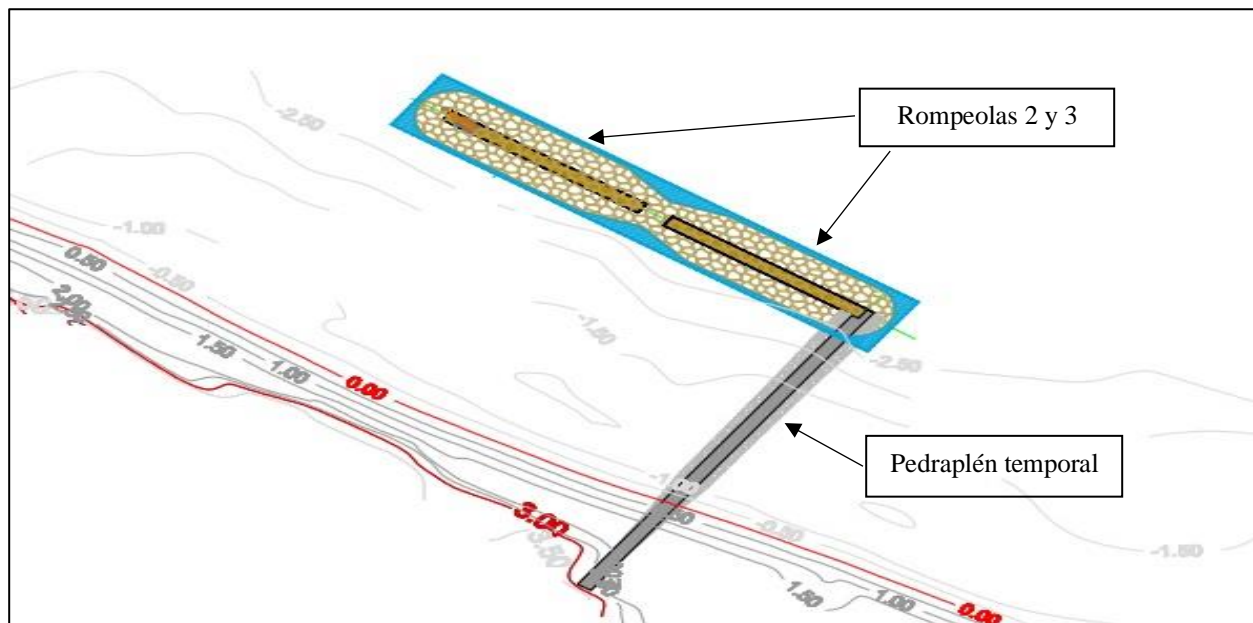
Ubicación del pedraplén temporal para construir rompeolas 2 y 3, en la zona M1.
